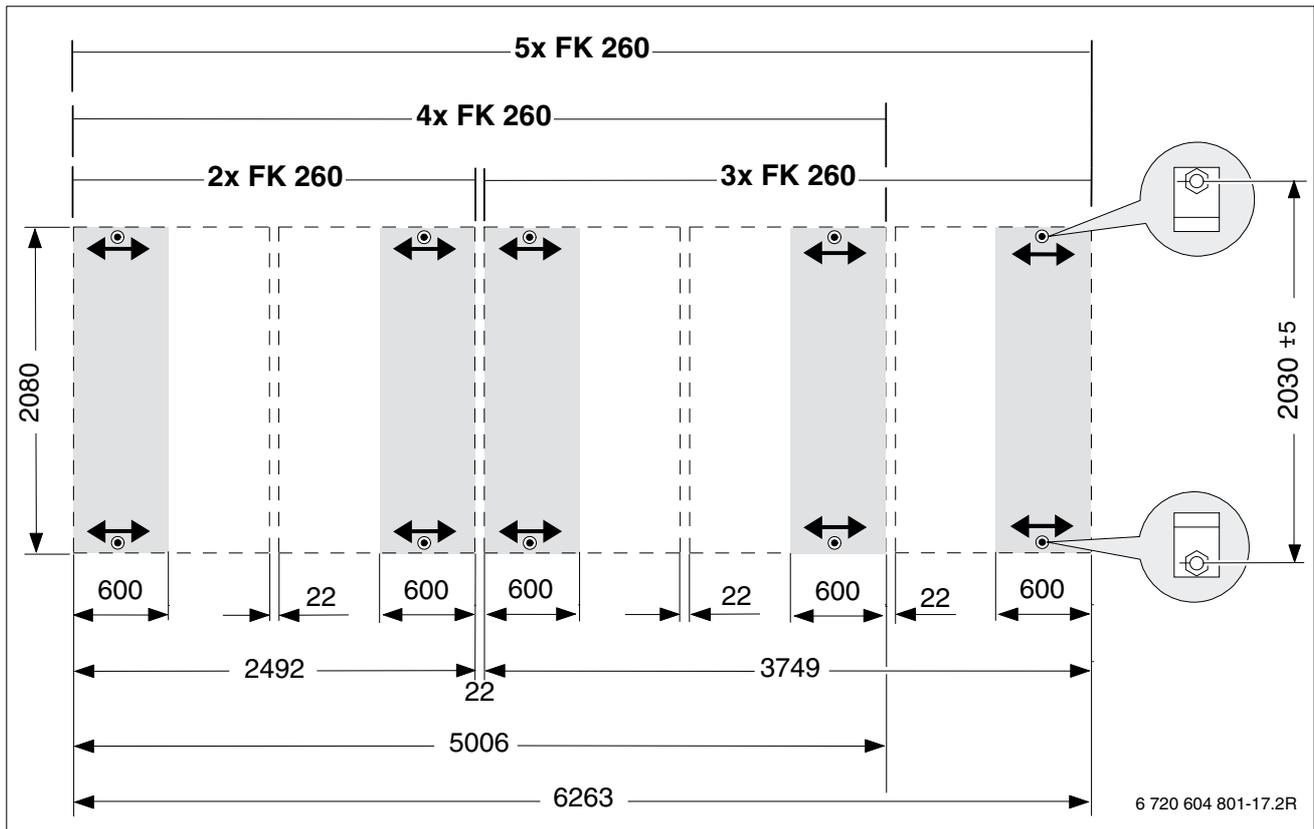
Kollektorfeldmaße und Toleranzbereiche für die Befestigung der Stockschrauben
